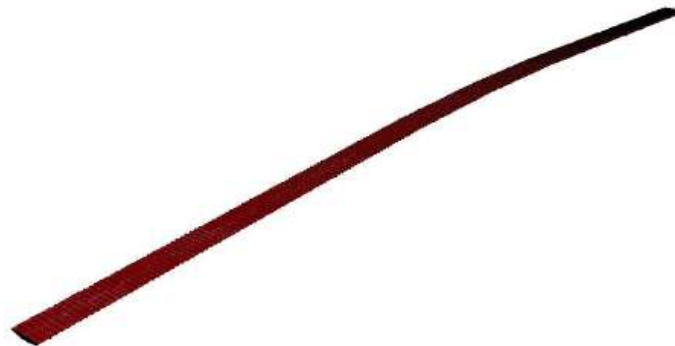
Alineamiento y tablero del puente atirantado con una longitud de 1180 metros.
